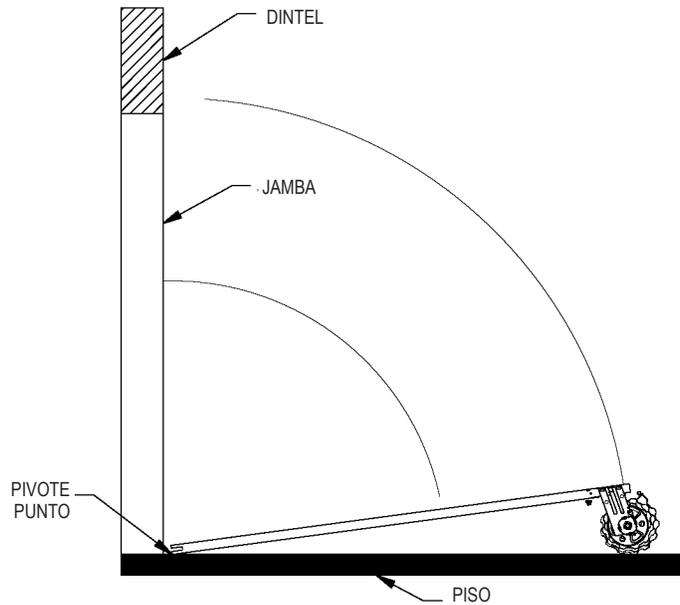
ELEVACIÓN DEL CONJUNTO DE LA PUERTA
